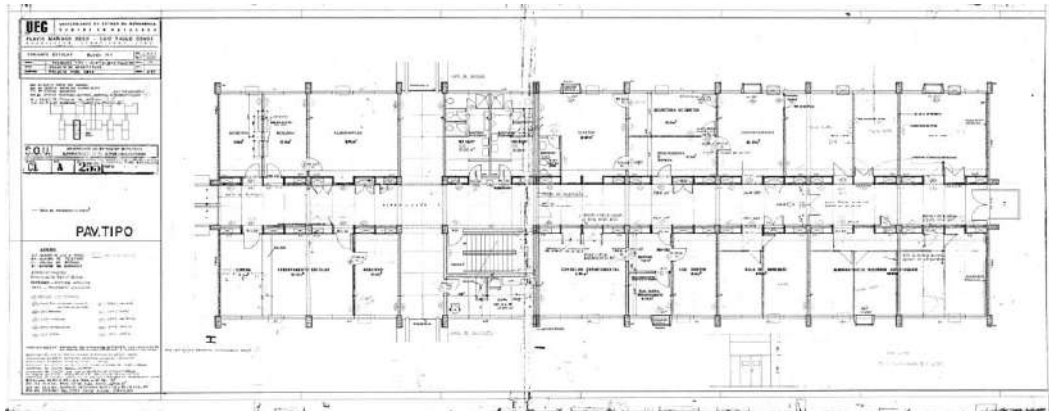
UERJ. Conjunto Escolar. Pavimento Tipo. Projeto para obra. Blocos H,I.
